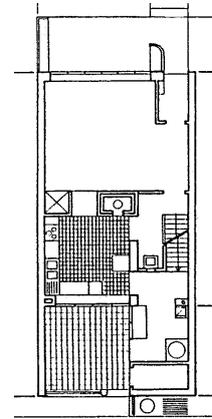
J. J. P. Oud: Erdgeschossgrundriss seines Gebäudes an der Weissenhofsiedlung 1927, galt als Vorbild für Uno Åhrén.
